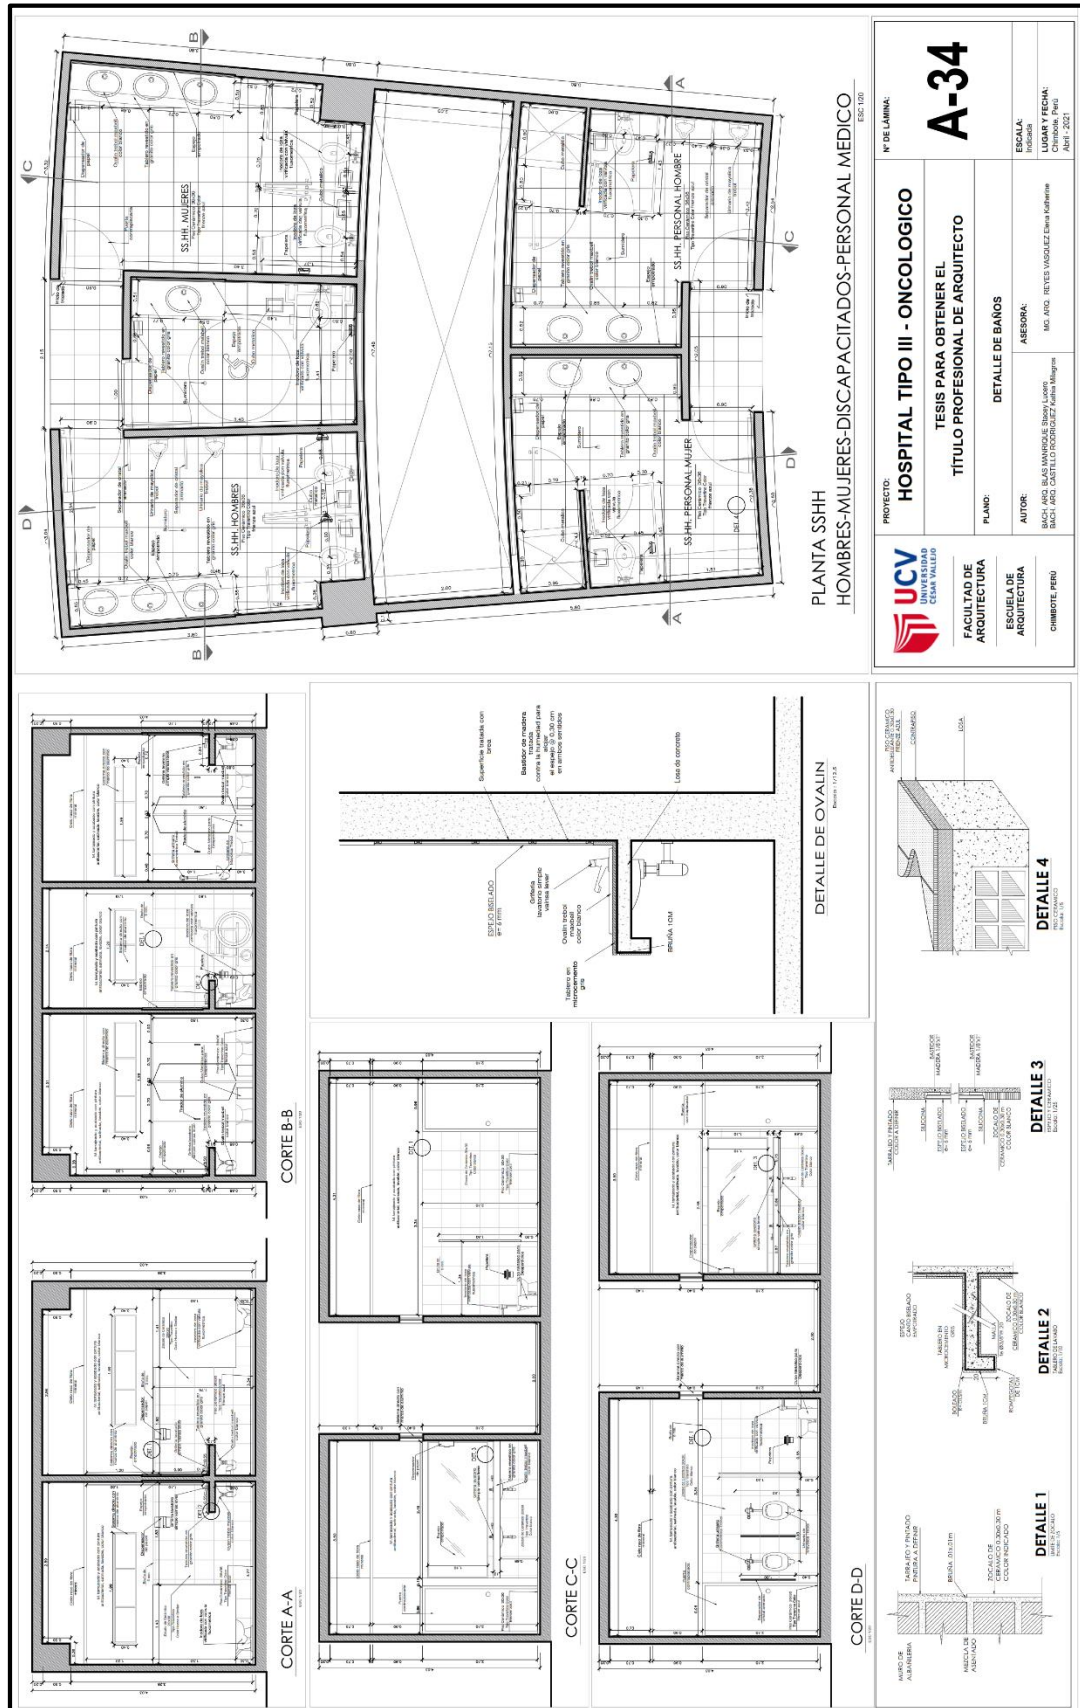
Plano de Detalle Arquitectónico - Baños
